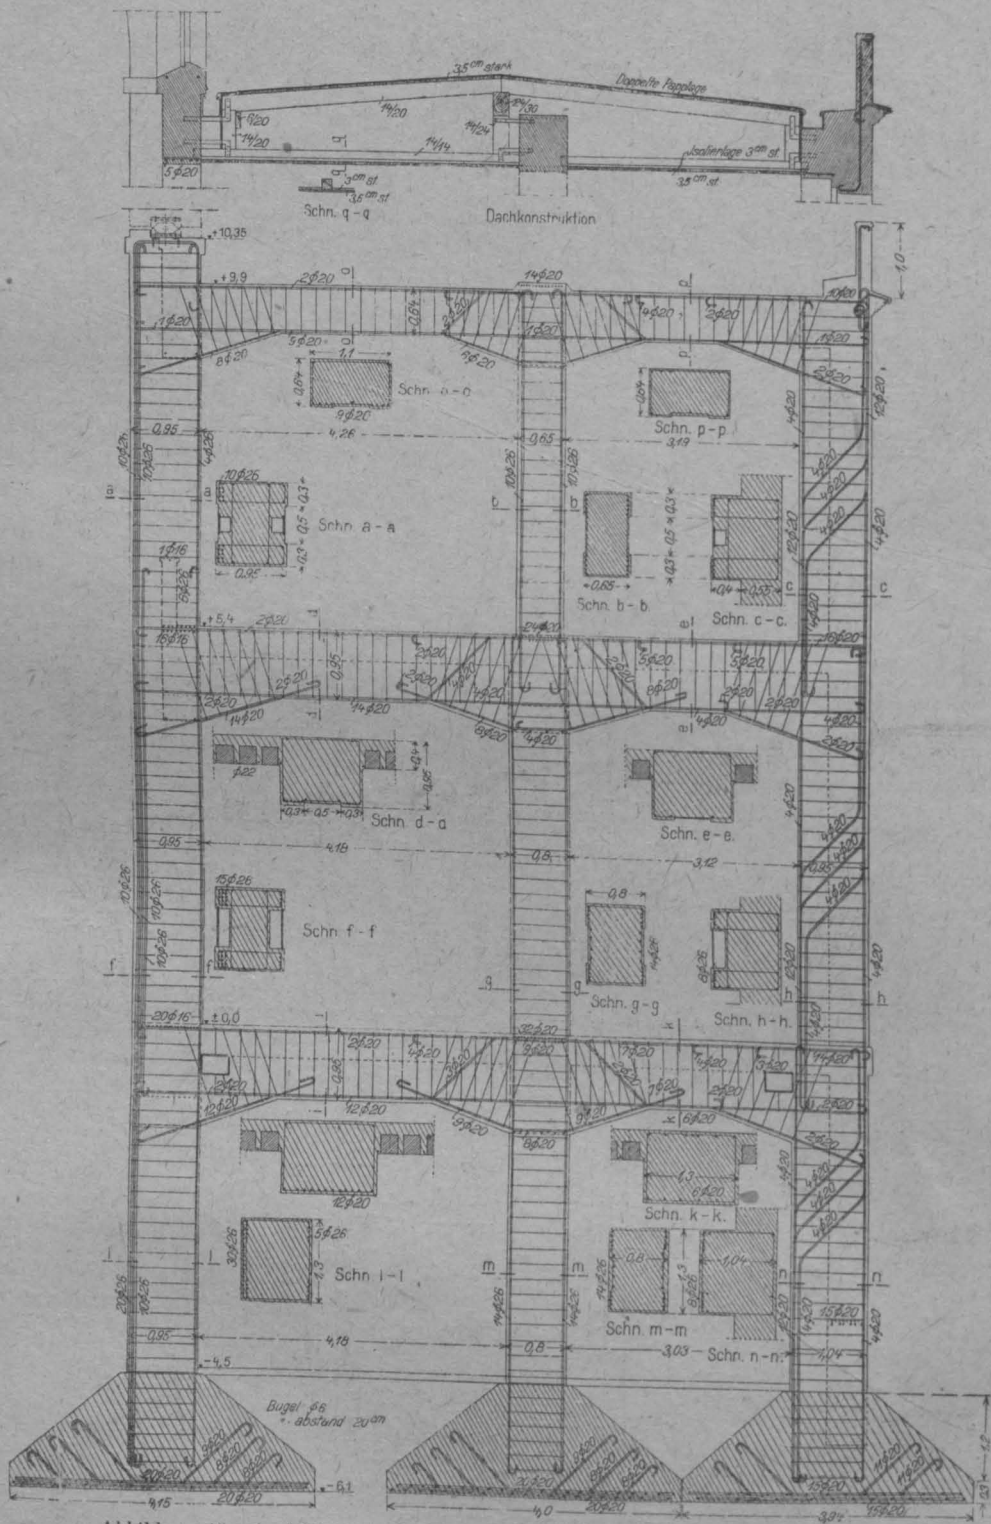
Ausbildung und Bewehrung der Stockwerksrahmen der Endbauten. Obst- und Gemüse-Großmarkthalle der Stadt Berlin.
